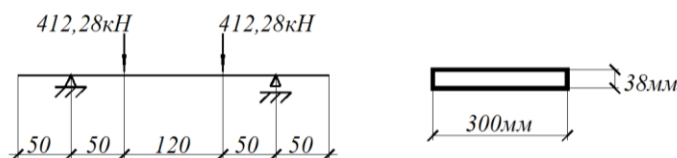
Розрахункова схема та поперечний переріз анкерної плиткі
